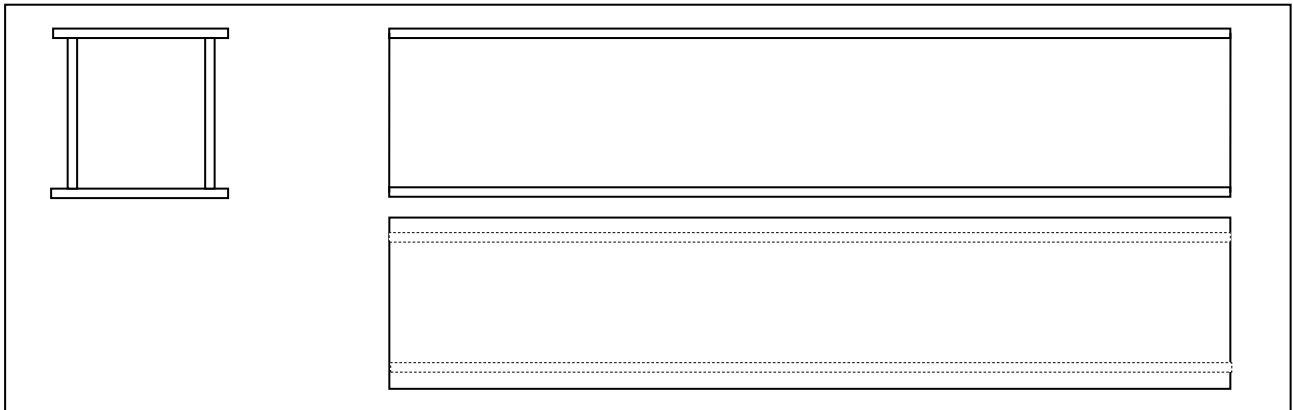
Différentes vues du PRS de la poutre maitresse
